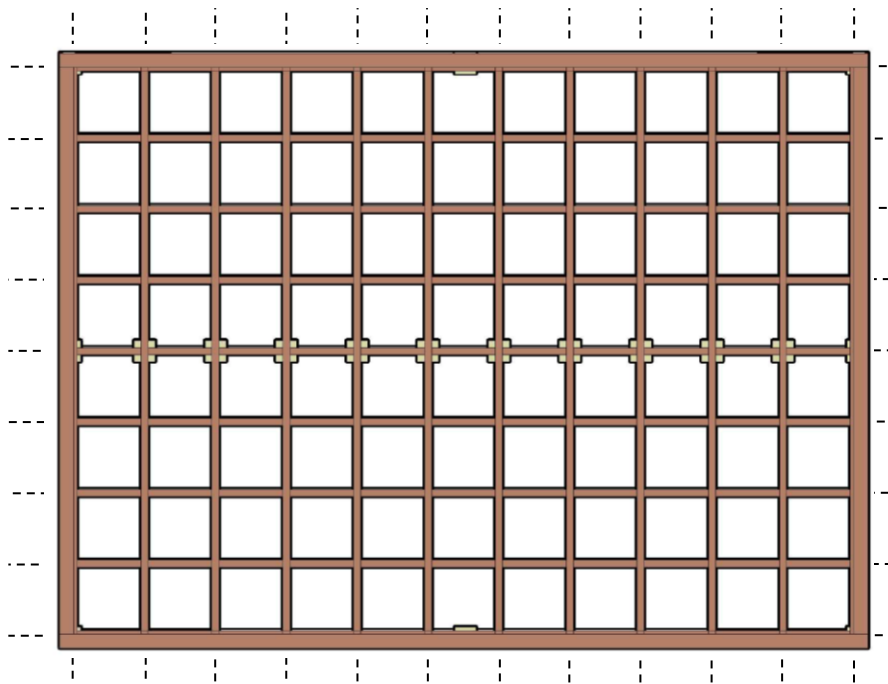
Planta da distribuição das vigas transversais e horizontais sobreposta a uma grelha espaçada de 1 em 1 metro no eixo das vigas.
